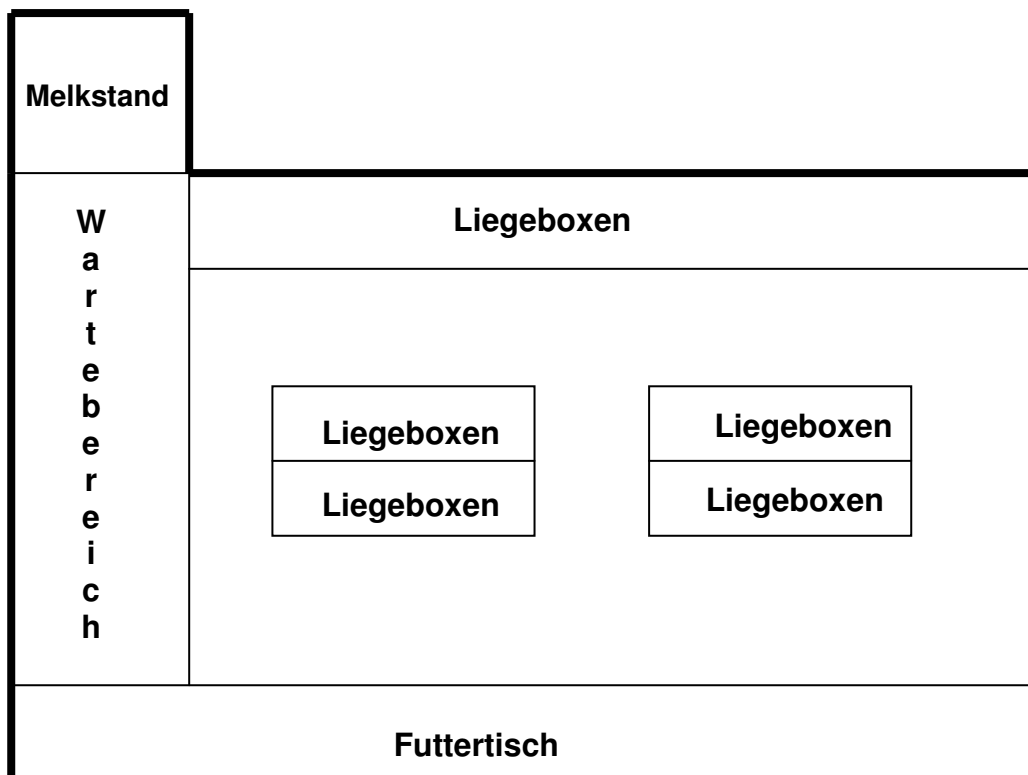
Grundriss-Skizze des untersuchten Stallabteils des neuen Stalls
